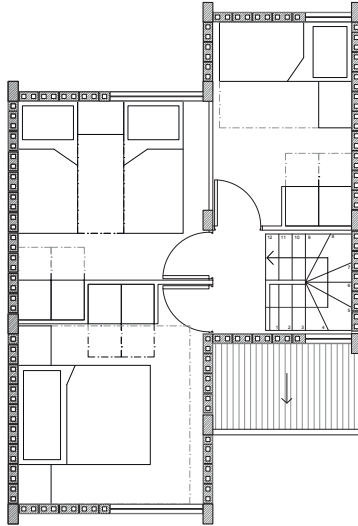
Área contemplada para ampliación de Vivienda duplex. Elaboración Propia en base a Planimetrías
